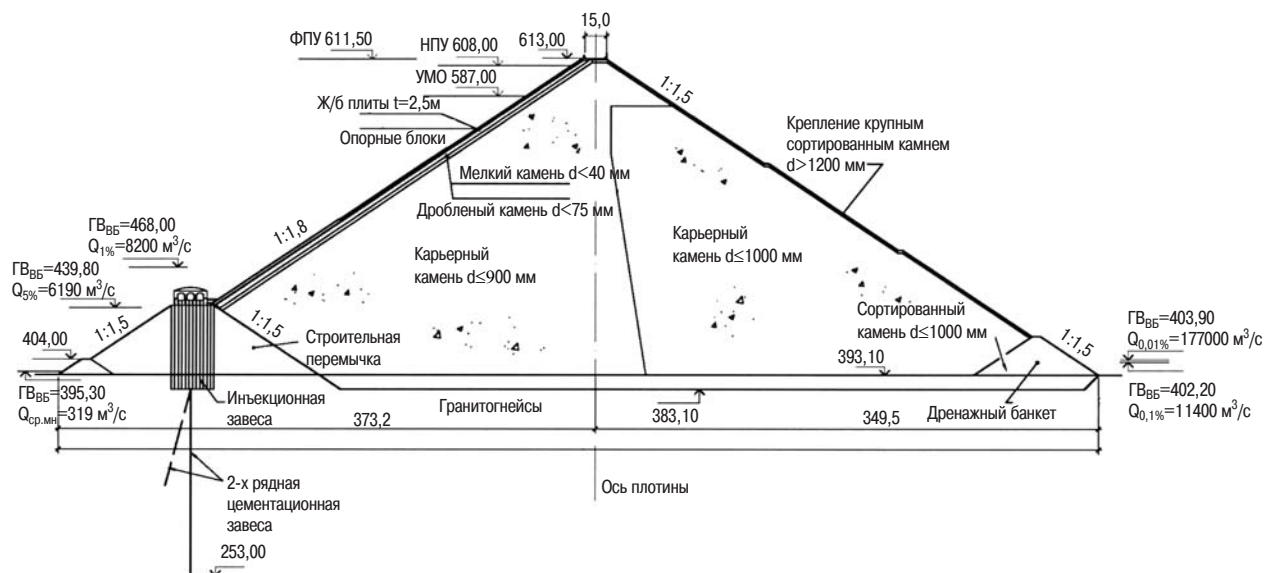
Поперечное сечение каменнонабросной плотины с железобетонным экраном
